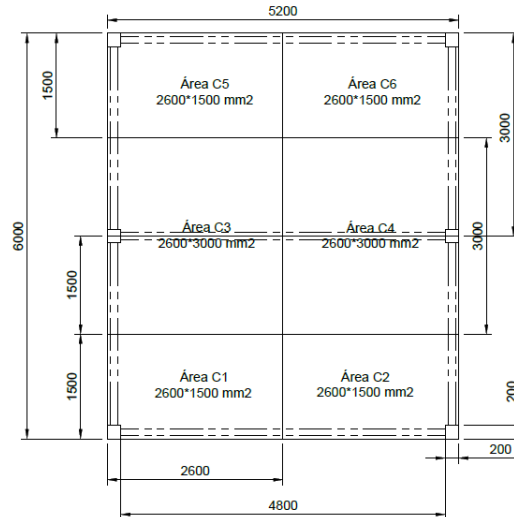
Dimensiones de áreas de losa para vigas y columnas.
